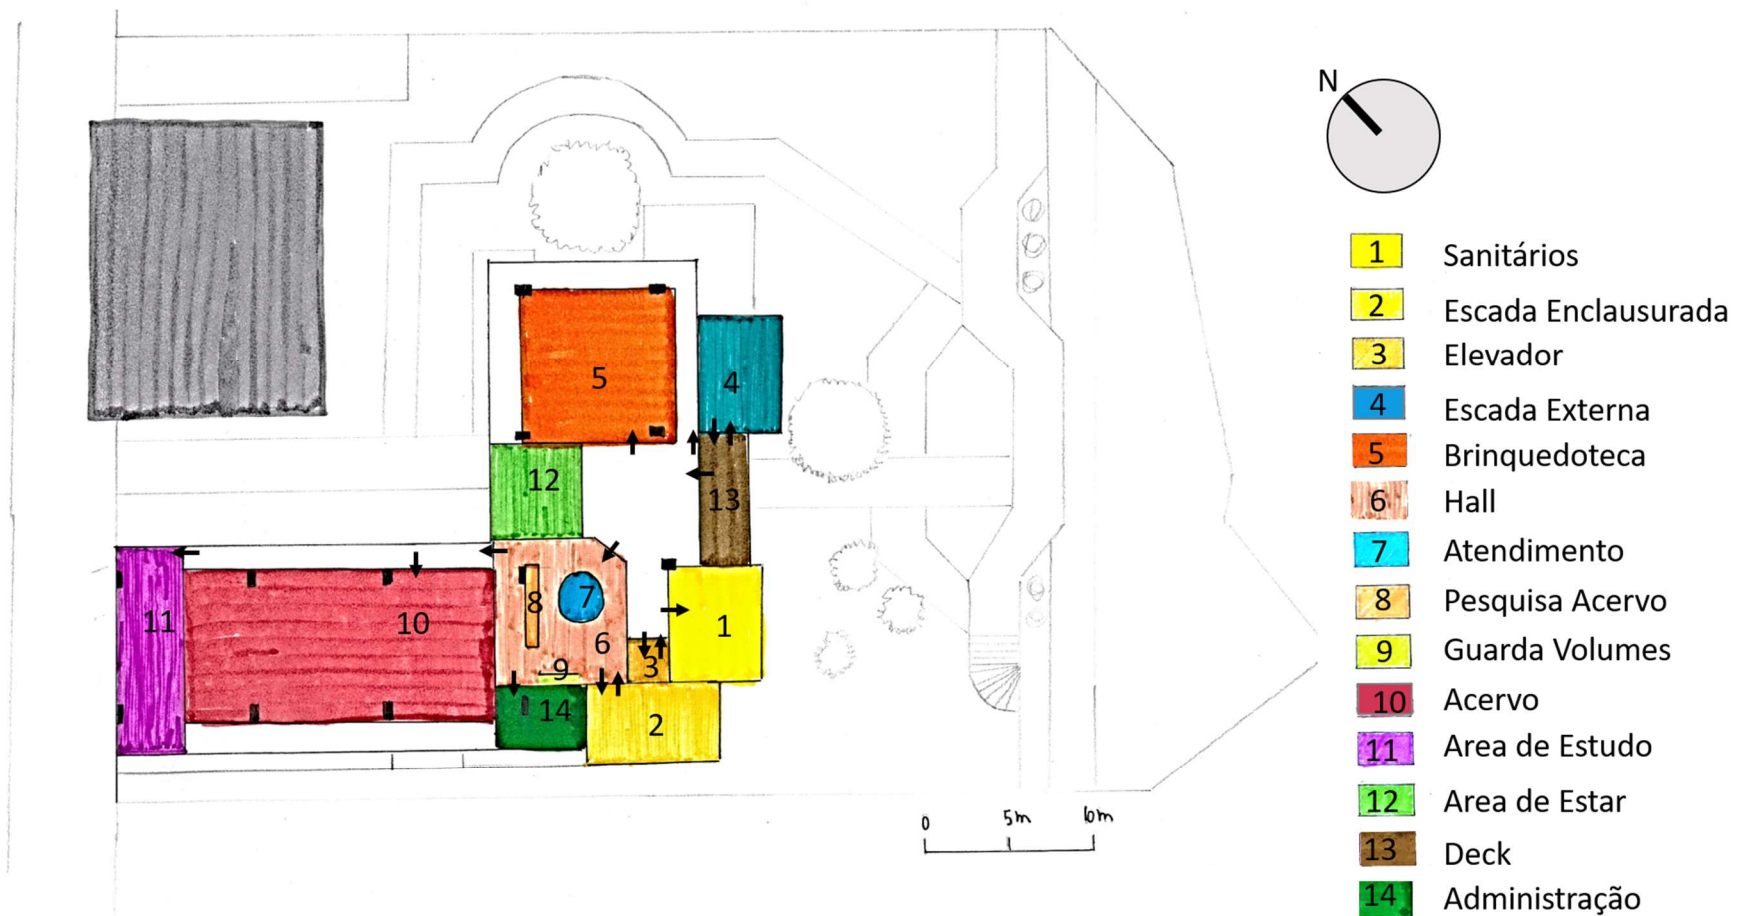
planta baixa terceiro pavimento. Fonte: Arquivo pessoal
